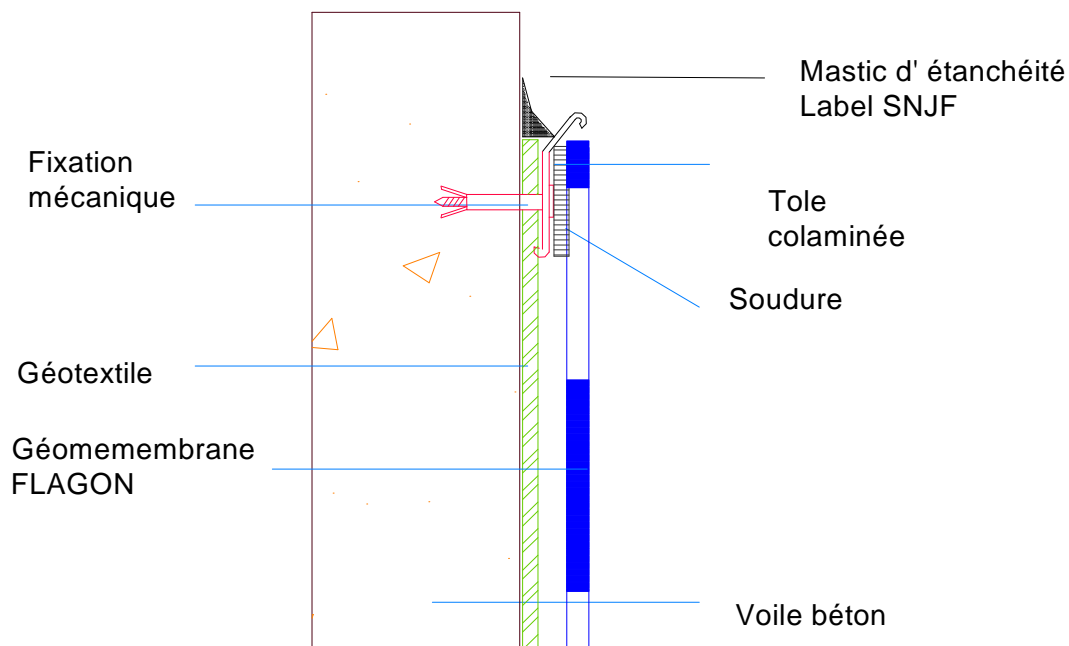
Fixation horizontale sur ouvrage béton
